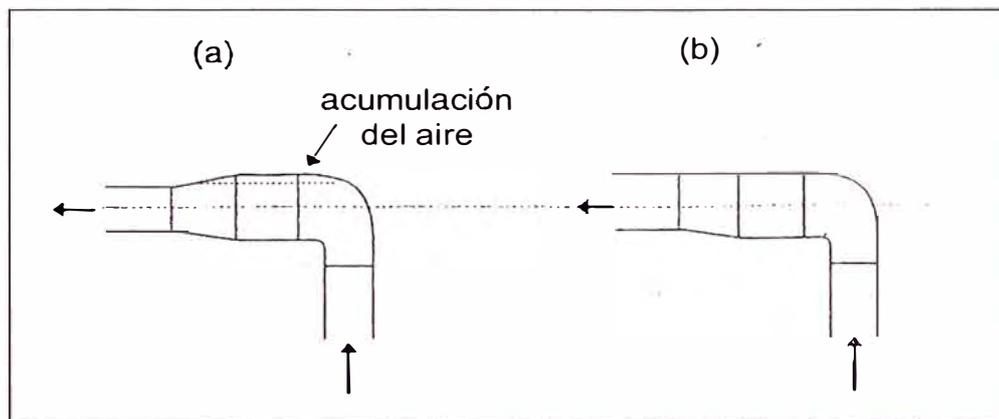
(a) Reducción excéntrica. (b) Reducción concéntrica.
